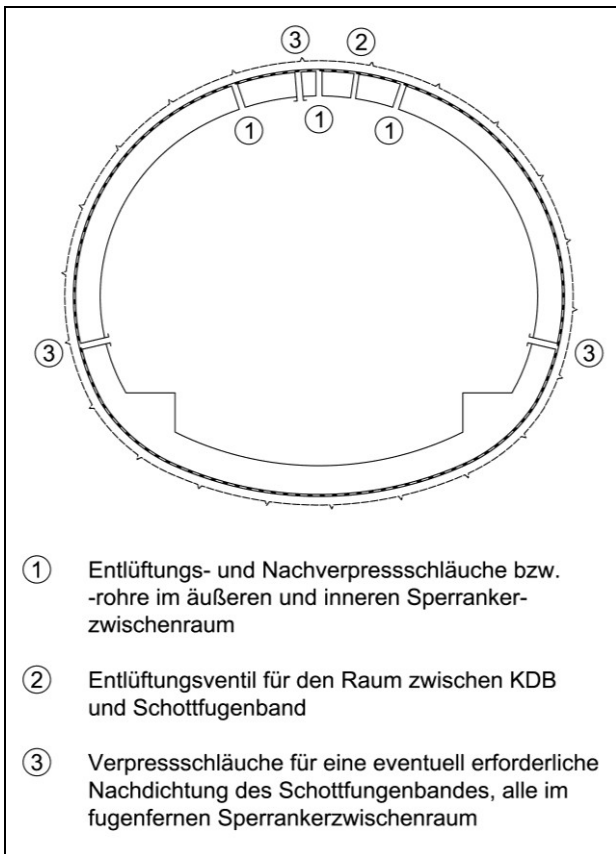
Entlüftungs- und Nachverpresseinrichtungen im Bereich der Blockfugen, Tunnel in geschlossener Bauweise
